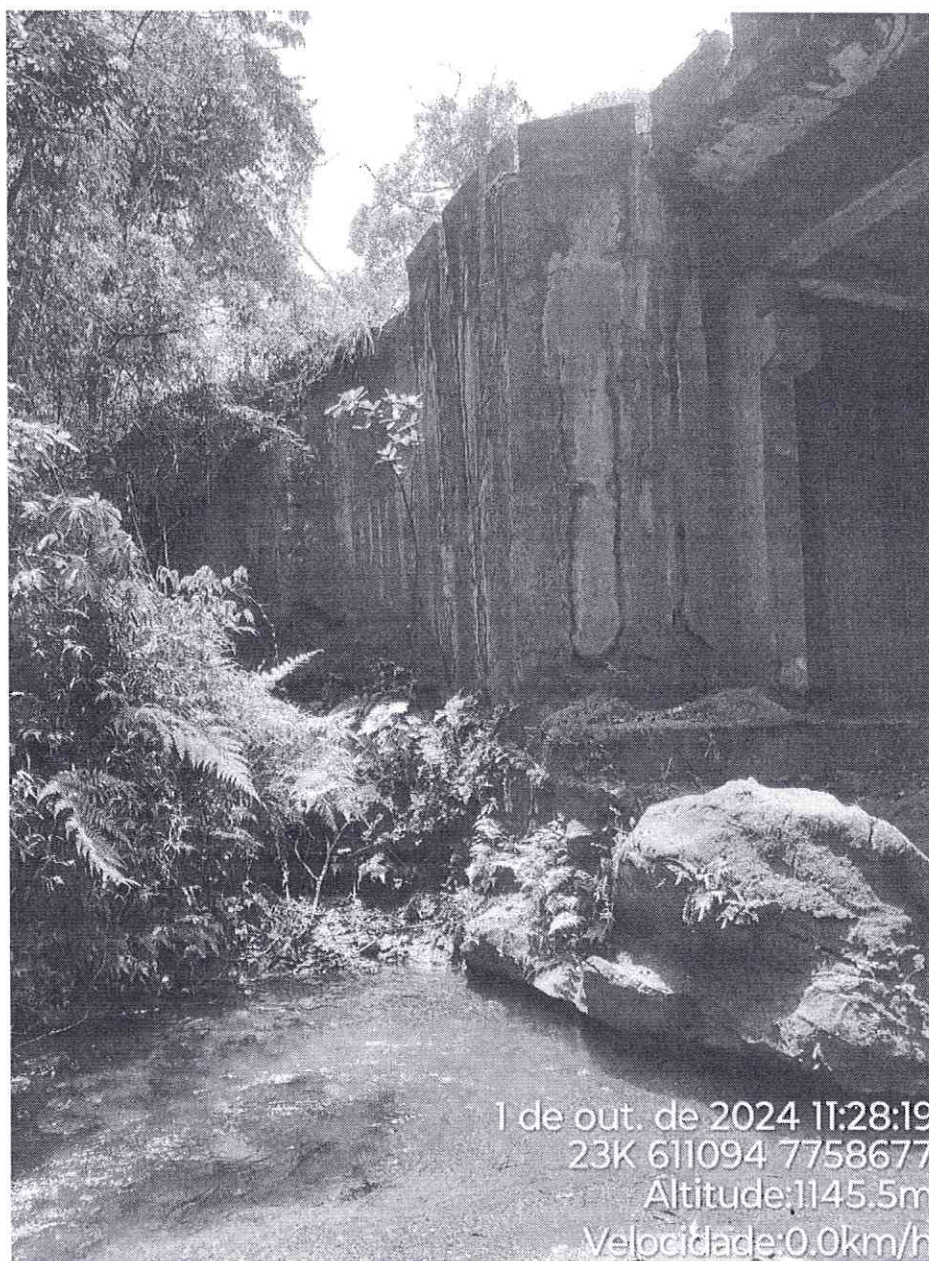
Vista da Área Diretamente Afetada. Fonte: SEMAM,2024.
